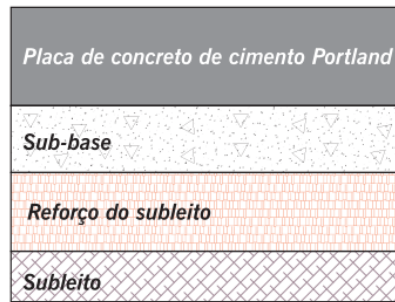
Perfil Tipo de um Pavimento Rígido
